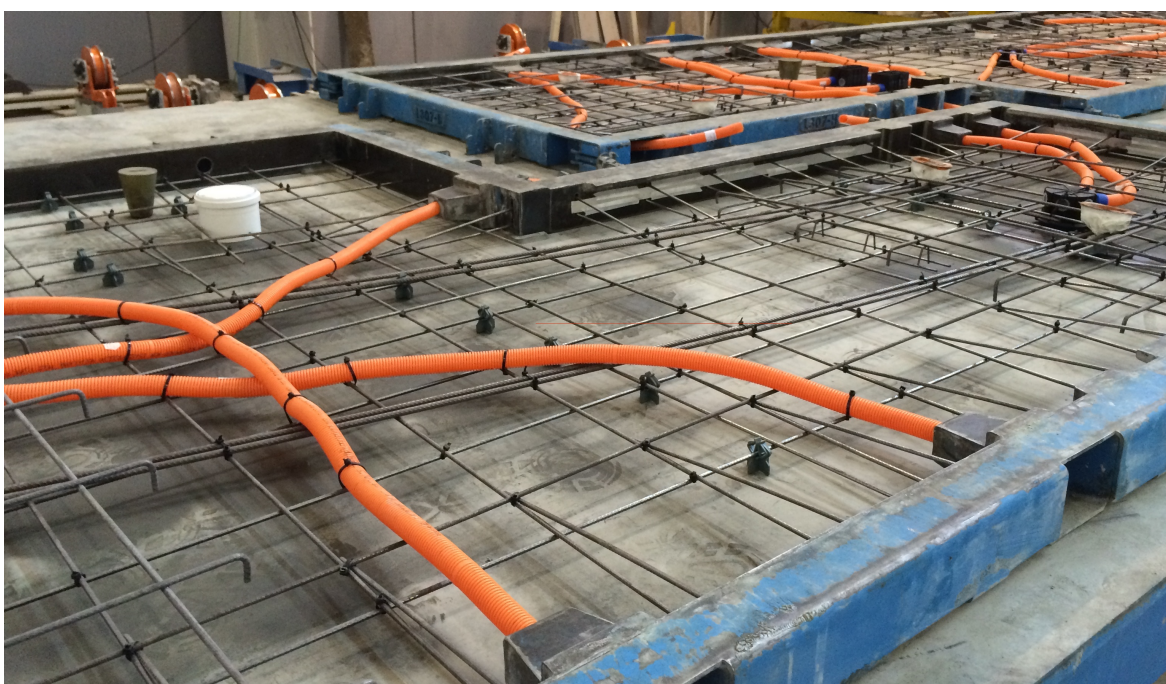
Formas para pré-fabricação. Fonte: cedida pela construtora (2018).
